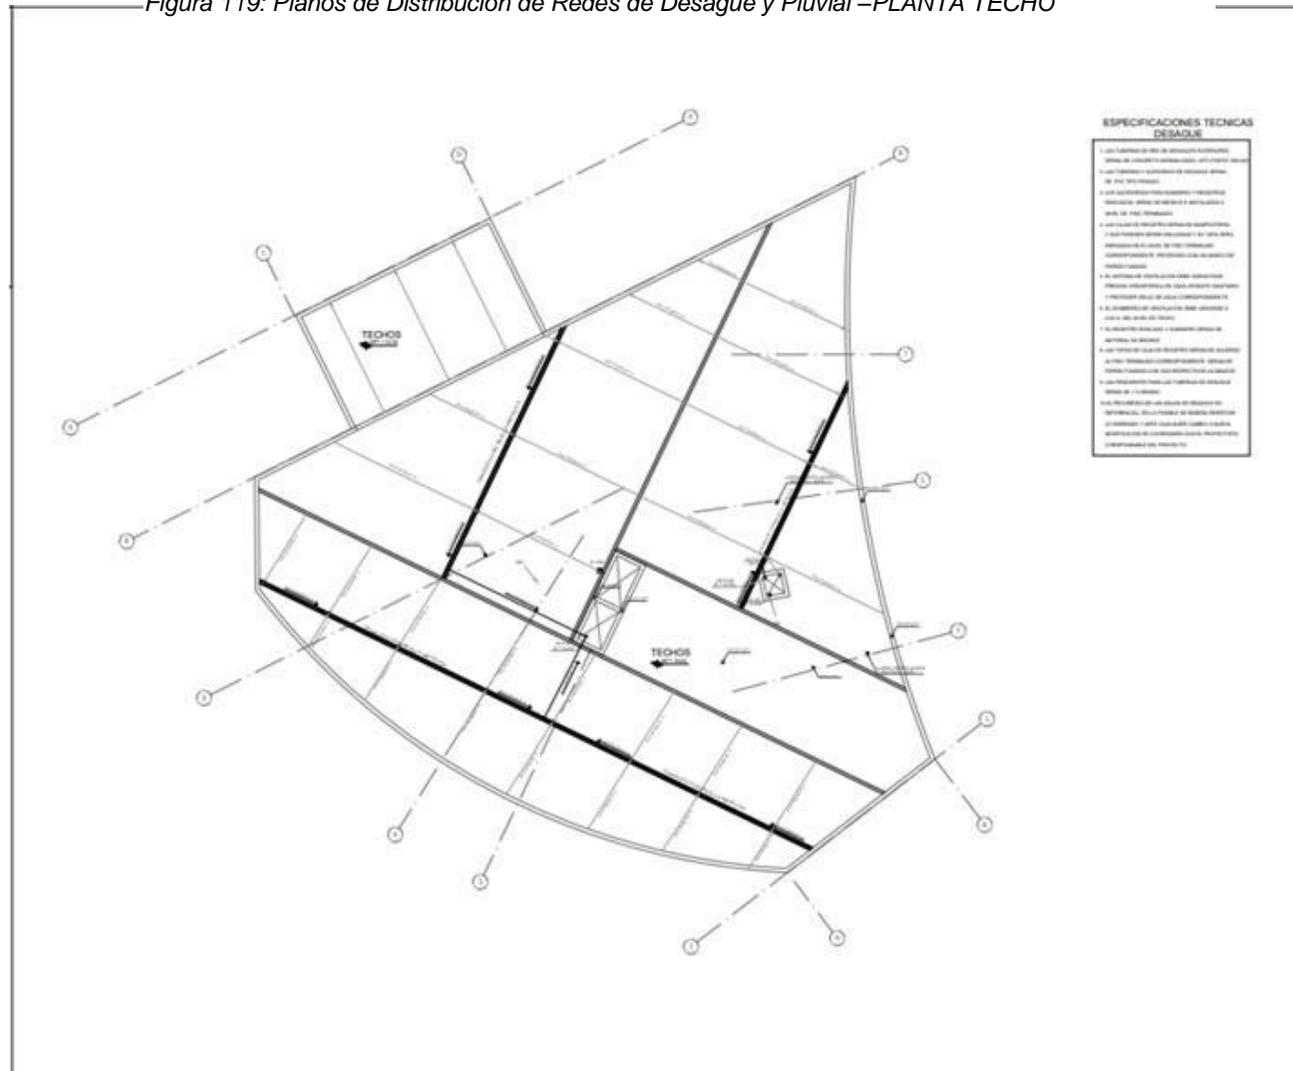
Planos de Distribución de Redes de Desagüe y Pluvial –PLANTA TECHO
